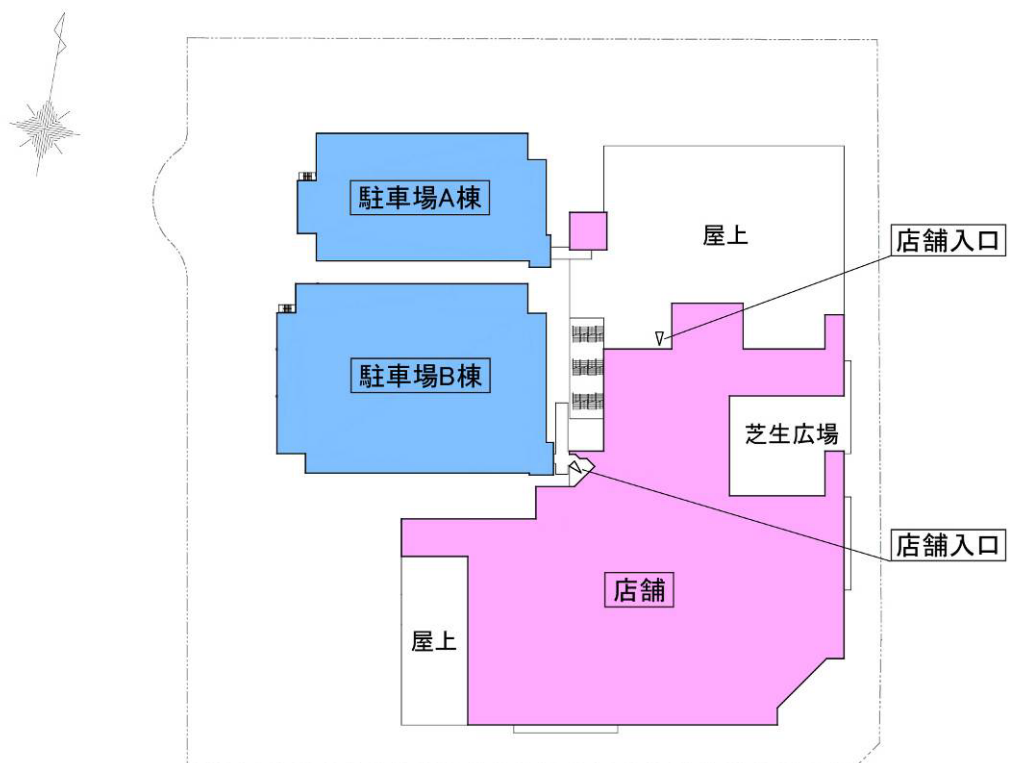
(4) 各階平面図(商業棟 4 階, 駐車場 A 棟 6 階, 駐車場 B 棟 6 階) 【変更後】
